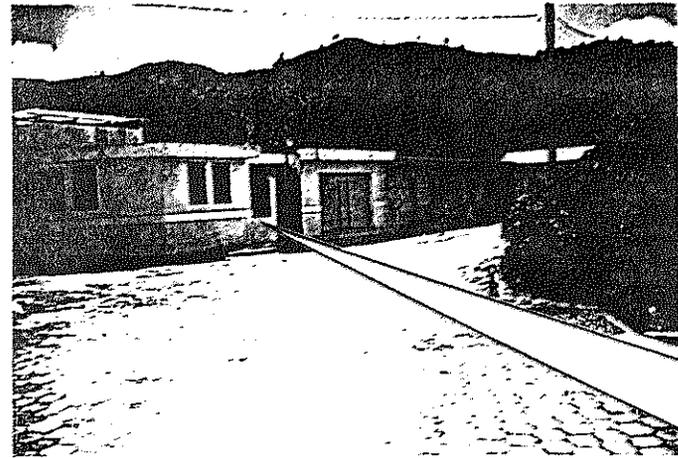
Obsérvese el predominio de block y concreto reforzado. el viario aparece por primera vez como parte de la fachada; en las fotografías anteriores las ventanas fueron hechas de madera abanables como las puertas. De este tipo se muestran en adelante, representando a las últimas construcciones en el municipio.
